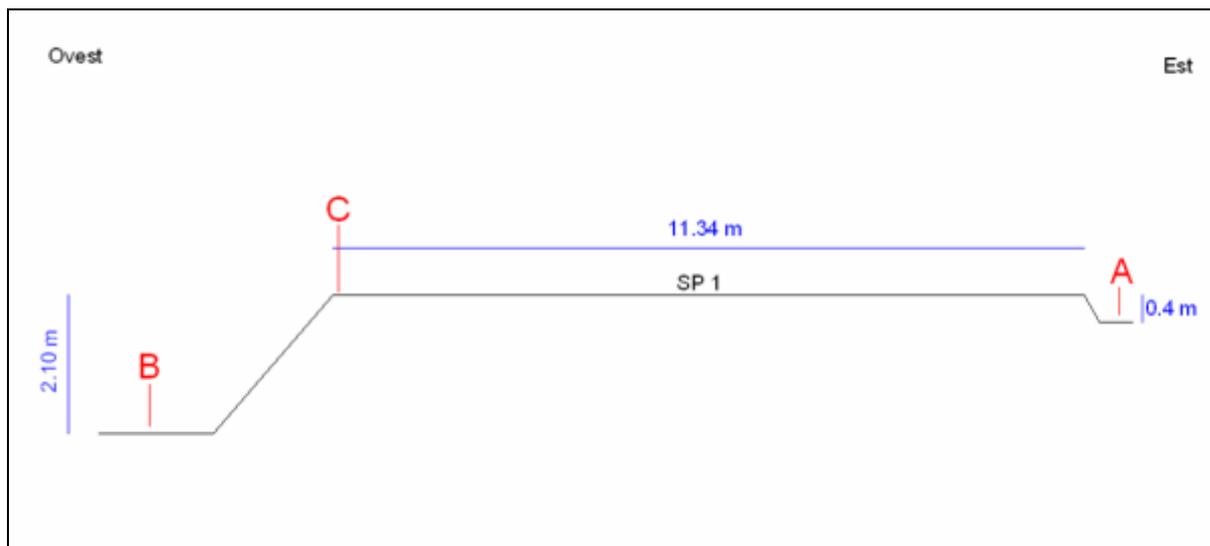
Sezione schematica del tratto stradale di interesse (SP 1)
